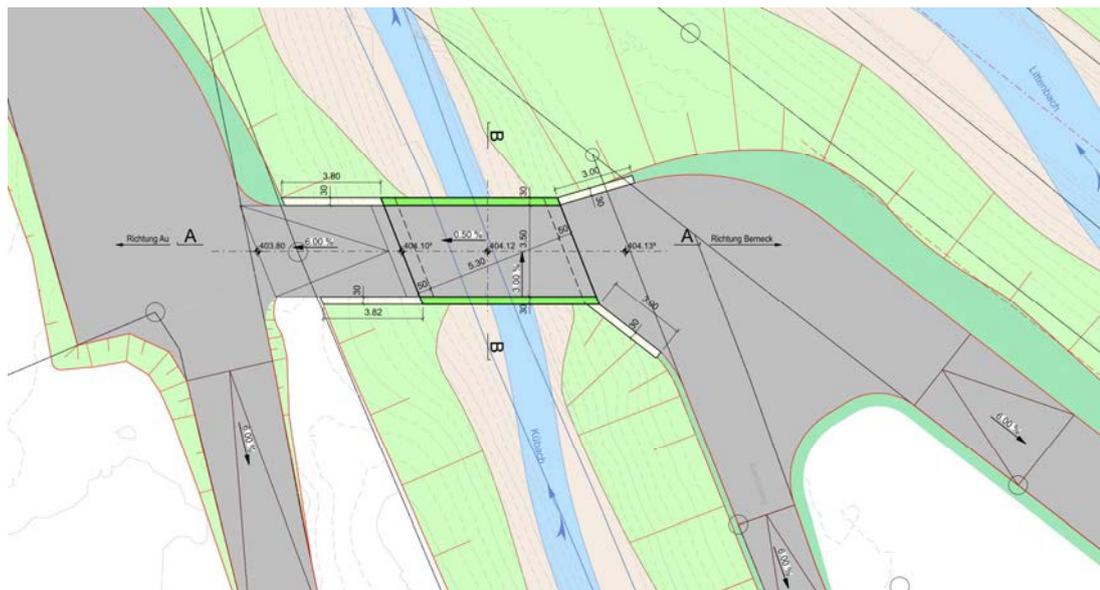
Horizontale Linienführung Brücke Littenbachweg, Kübach
